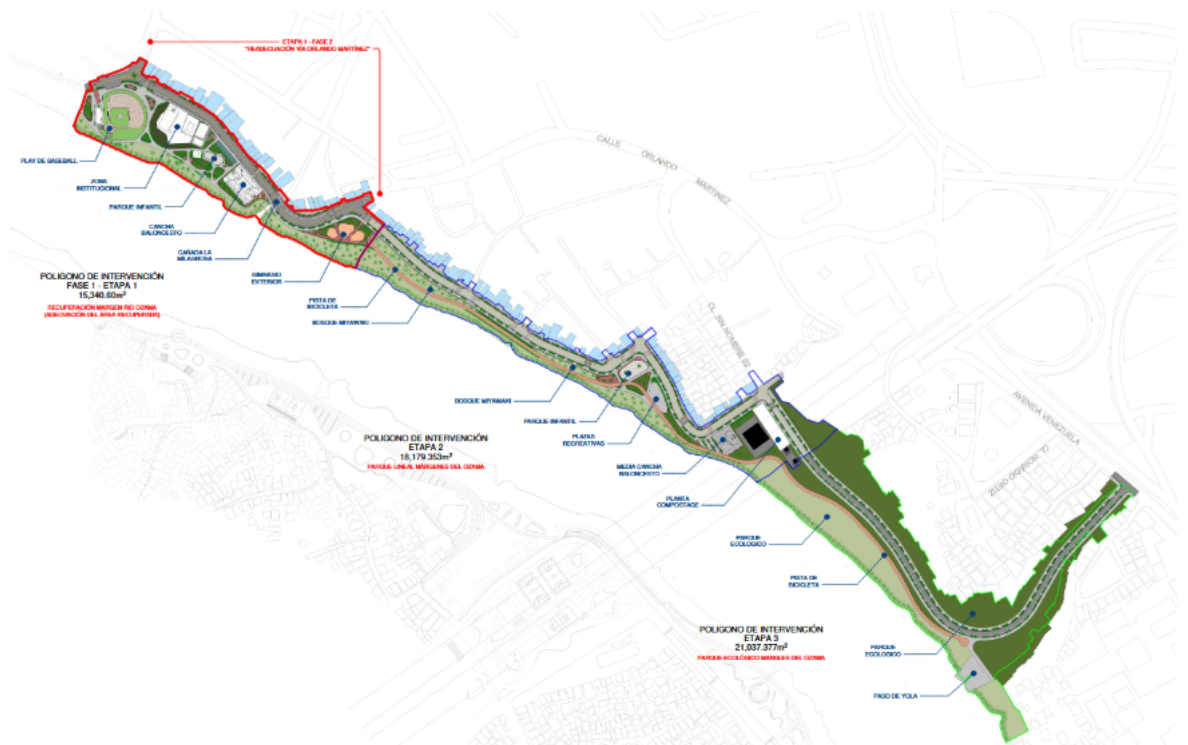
Las Lilas y la vía prevista. Fuente : Masterplan de noviembre 2025 de URBE
